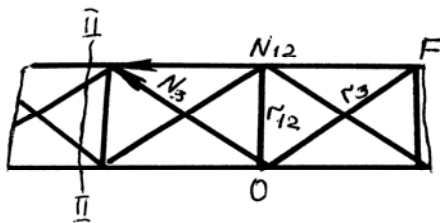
Схема к расчету усилий в стержнях 12 и 3
